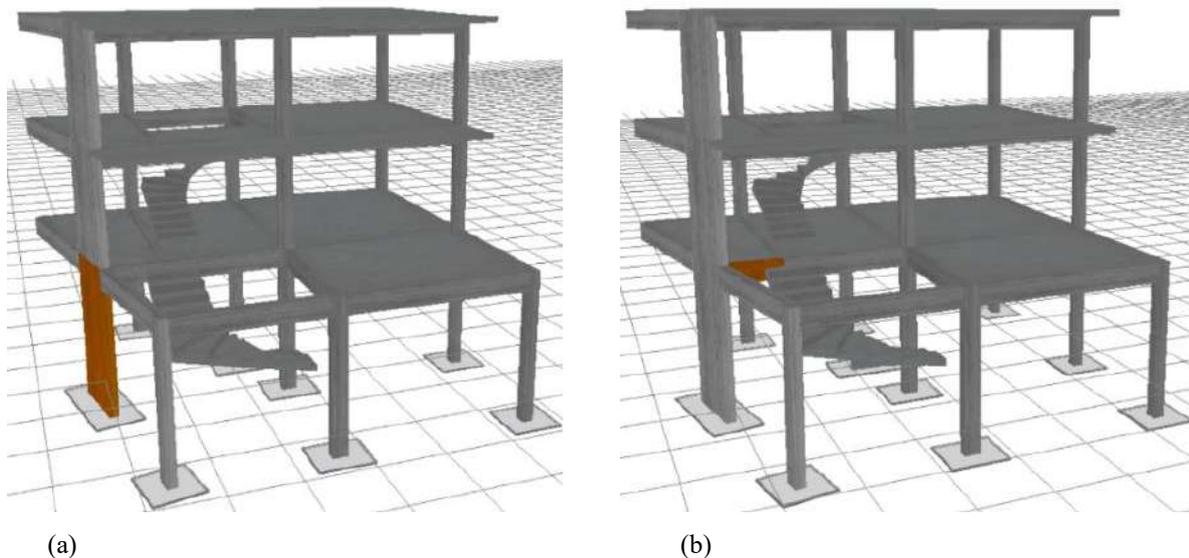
Konfigurasi bangunan beton bertulang eksisting.
